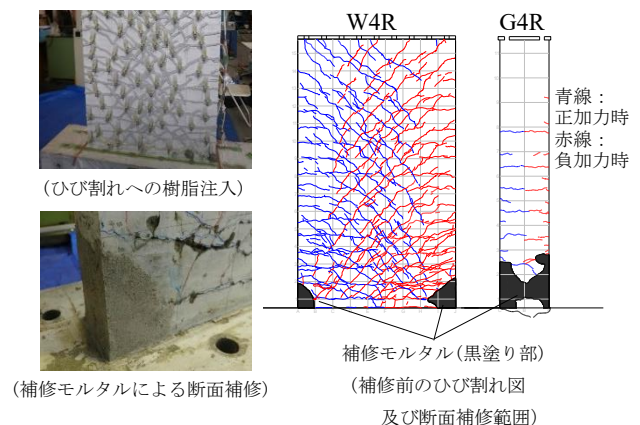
試験体の補修前のひび割れ状況及び補修状況
